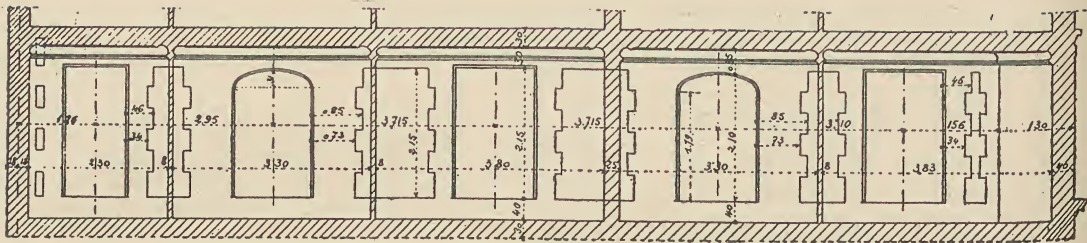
Élévation intérieure du mur de façade au 1<sup>er</sup> étage sur le boulevard Rochechouart.
